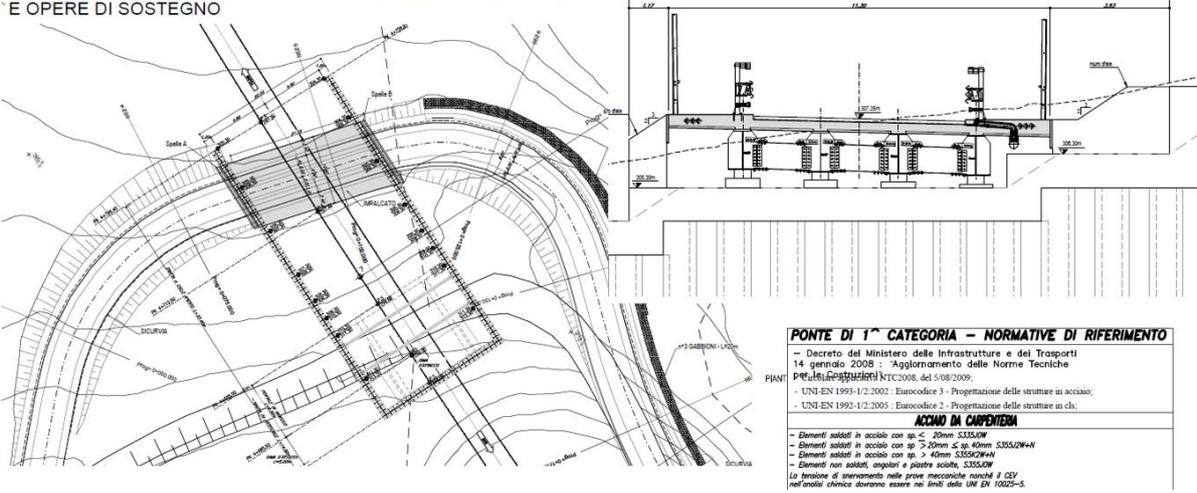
Planimetria e profilo NV05 deviazione provvisoria
